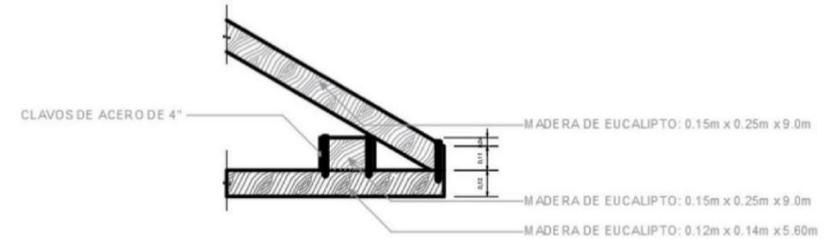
Detalles técnicos constructivos de la cubierta.
